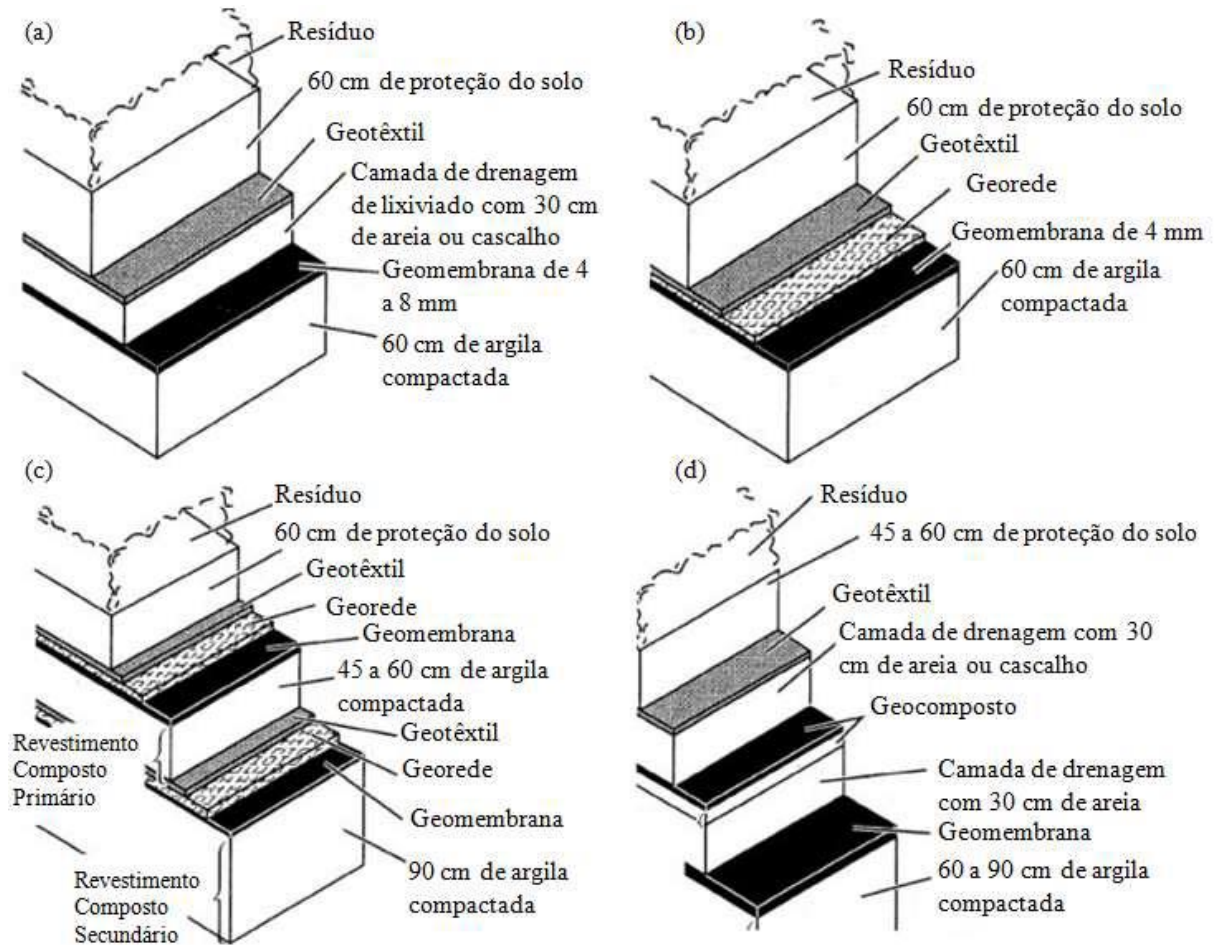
Configurações de impermeabilização de base em um aterro sanitário. Fonte: Ribeiro, 2016.
